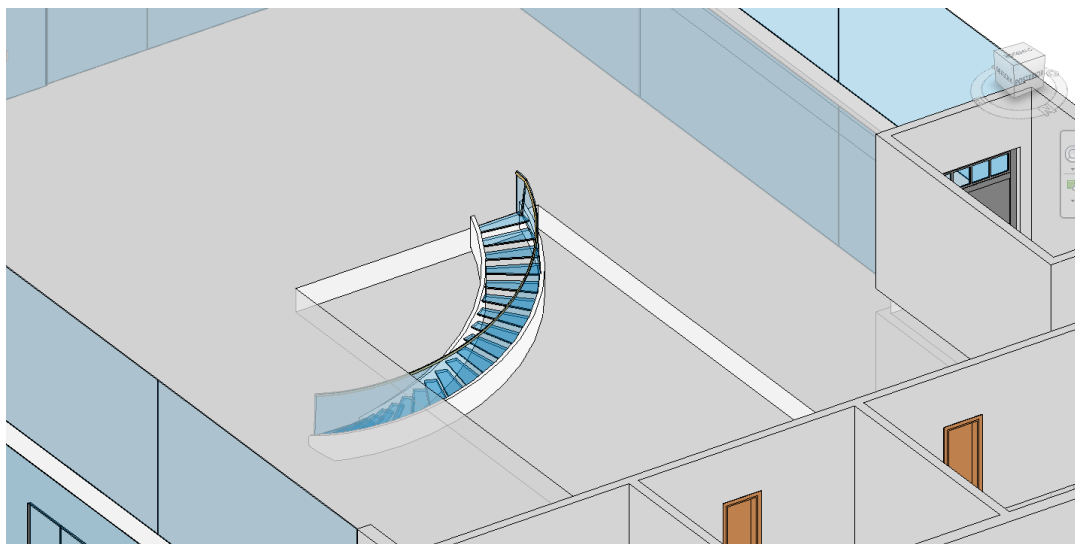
Vista 3D escalera de acceso a Primera Planta.
